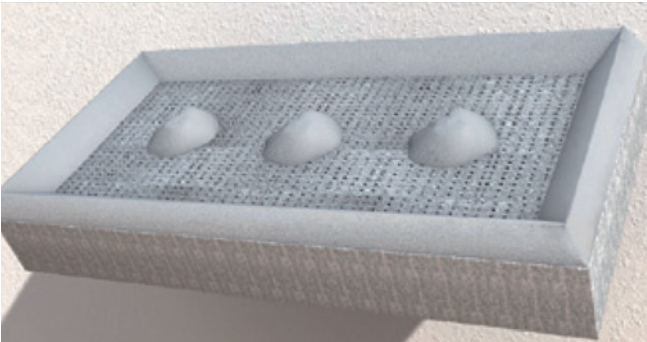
Randwulst-Punkt-Methode, schematische Darstellung anhand der Baumit FassadenPlatte open air
